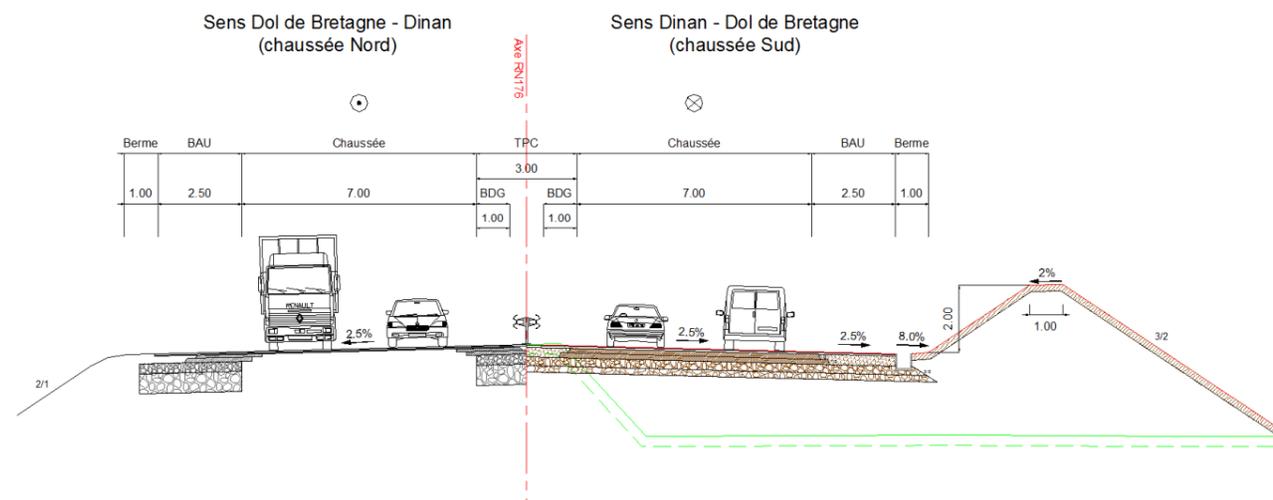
Profil en travers de la section courante en remblai avec merlon (source ARCADIS)
